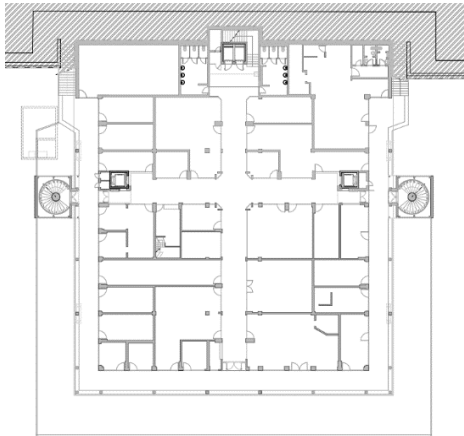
Planta Piso térreo, Centro comercial Girasolum.
